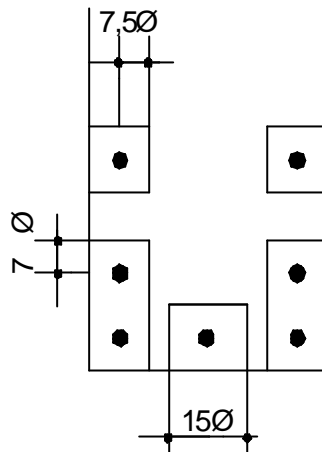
Área de concreto considerada no cálculo da taxa de armadura contribuinte (A_{ct}) contra fissuração.
